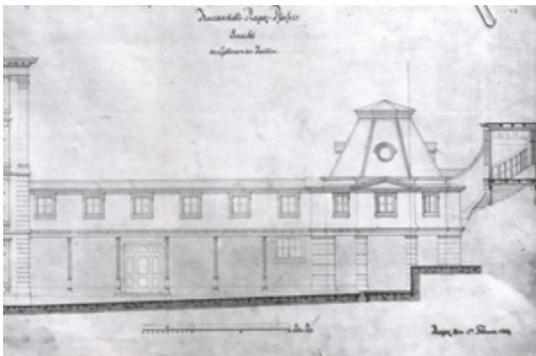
Bad Ragaz, Plan 29, Ansicht Galerie und Trinkpavillon
